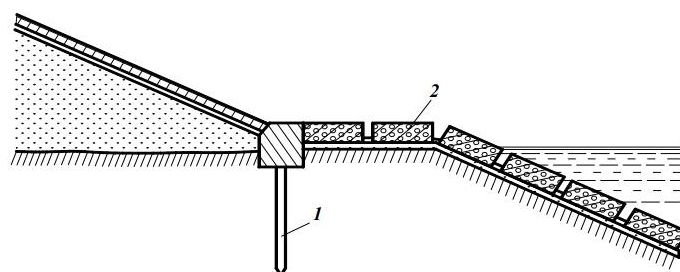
Берегоукрепление железобетонными тюфяками:
